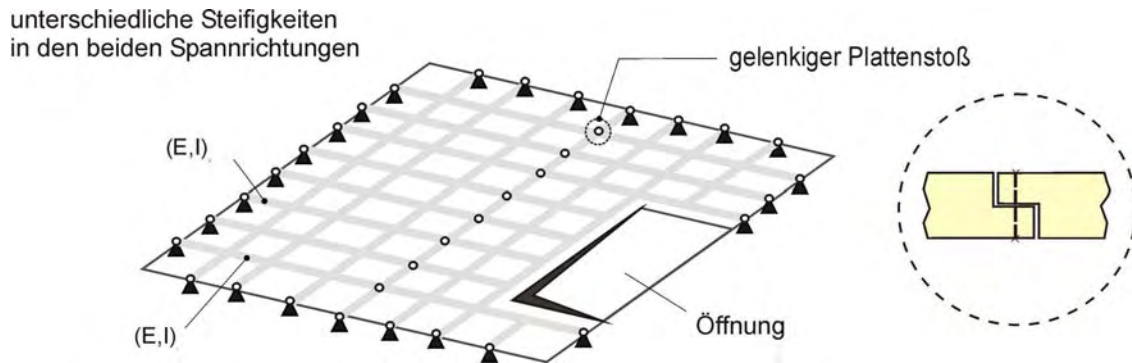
Modellbildung einer zweiachsig lastabtragenden Deckenplatte mit Hilfe eines Trägerrostmodells (unter Berücksichtigung eines Plattenstoßes und einer Öffnung)
